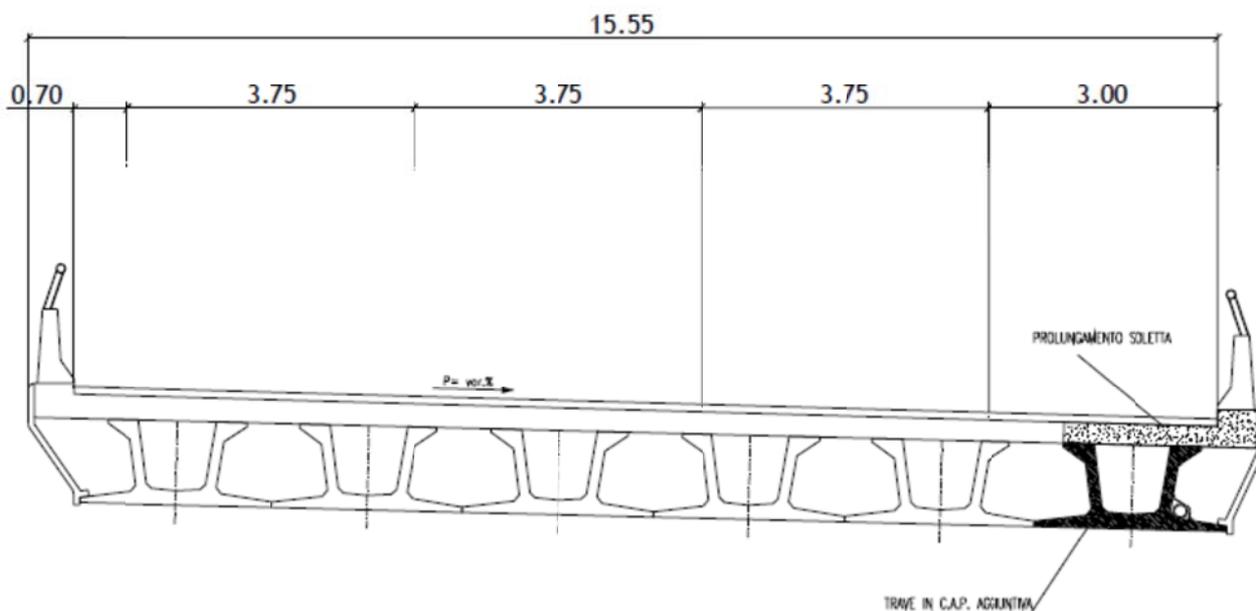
SEZIONE TIPICA IMPALCATO CON TRAVI IN CAP DI PP
